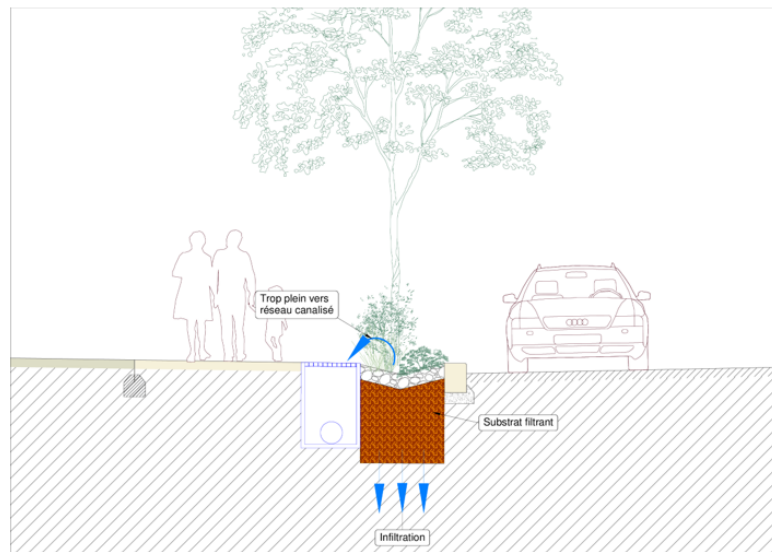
Coupe de principe de la noue plantée et localisation des noues associées au boomerang.
